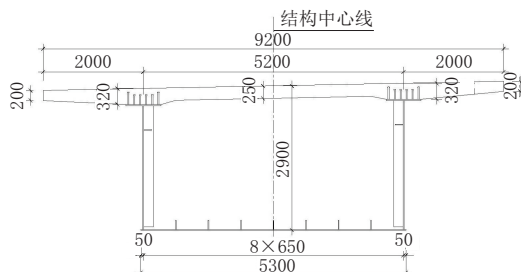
钢混组合梁竖向加劲肋断面图(单位:mm)
